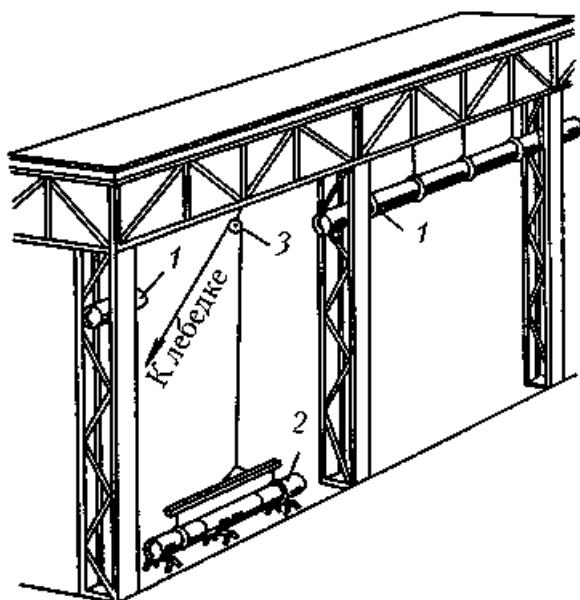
Монтаж воздухопроводов в межколонном пространстве:
